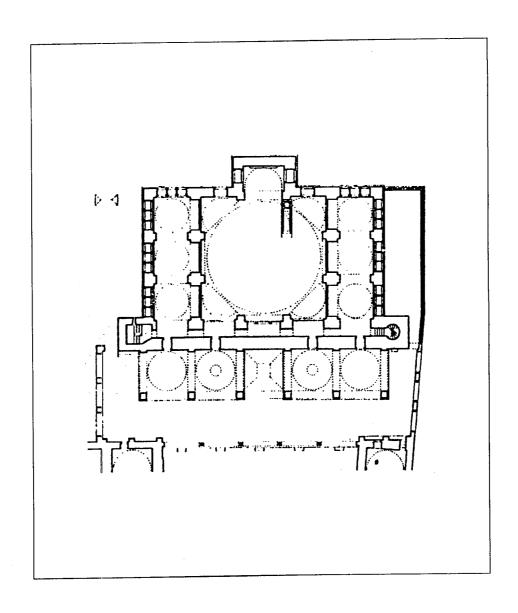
مسقط أفقي لمسجد مصطفى بك في سيريز (عن: كيل).
